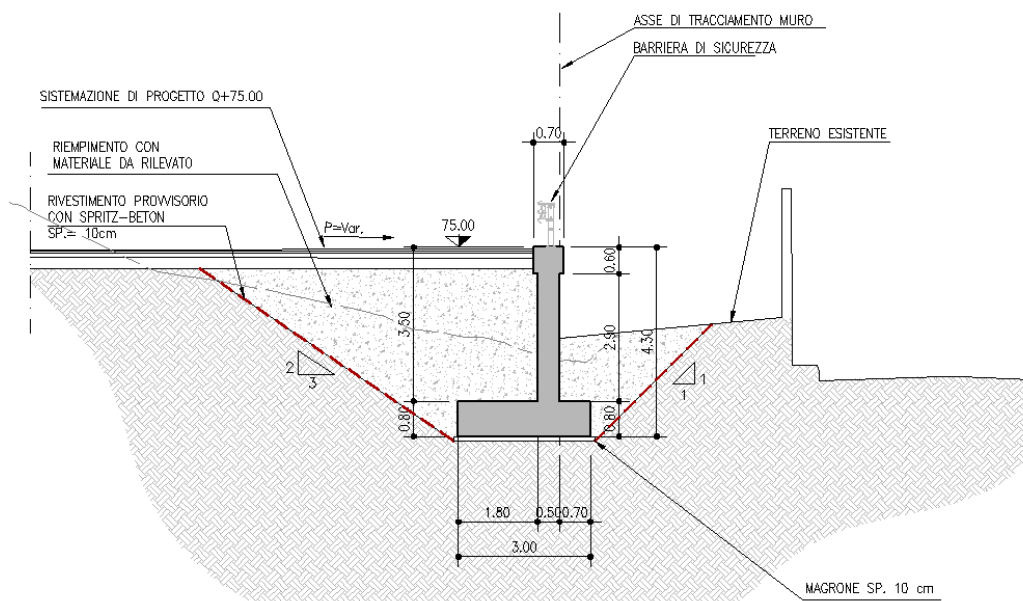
Muro di sostegno MS04 – Sezione tipo 1
